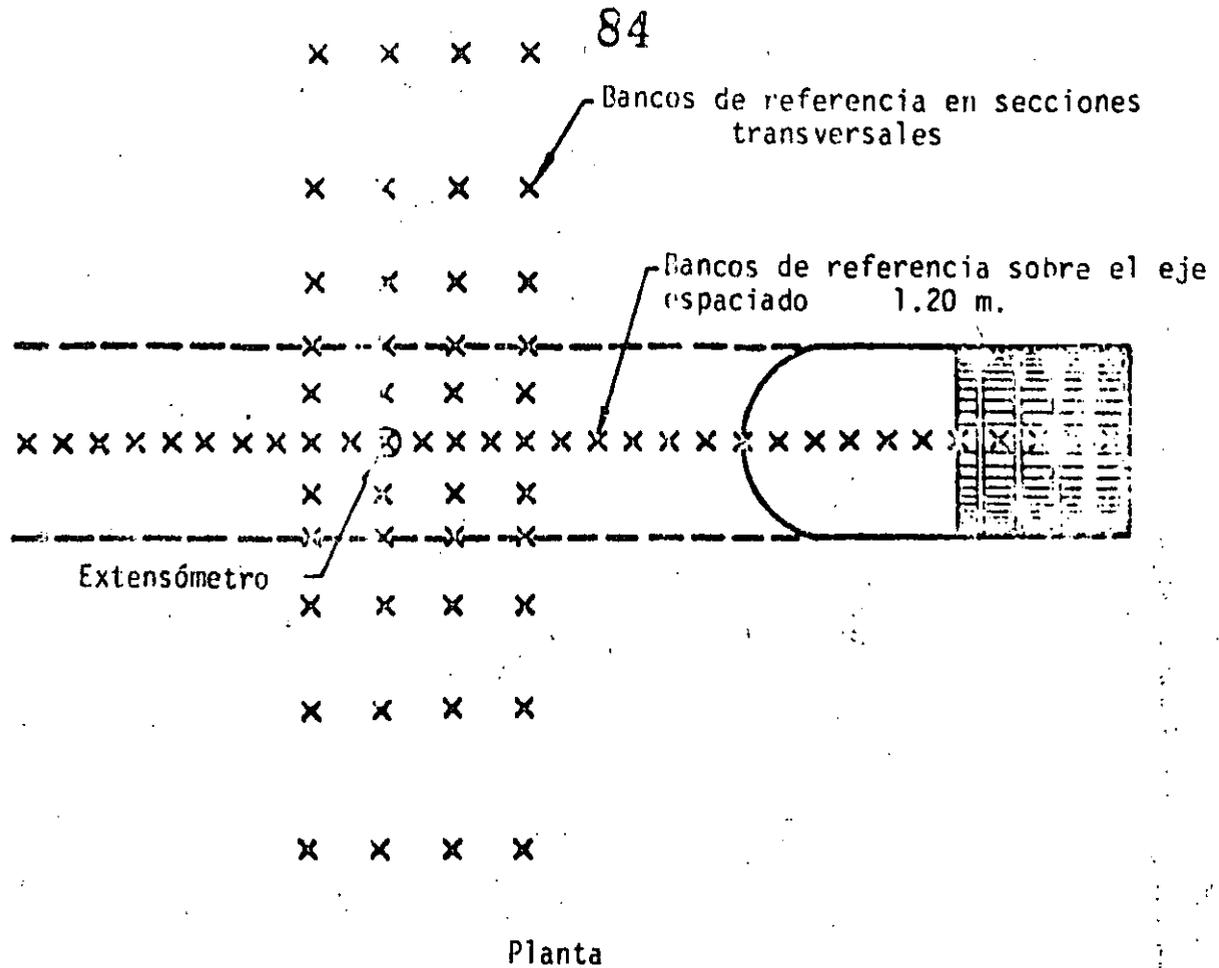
Instrumentación sencilla para detectar el origen de la pérdida de suelo, en un túnel excavado con escudo.
